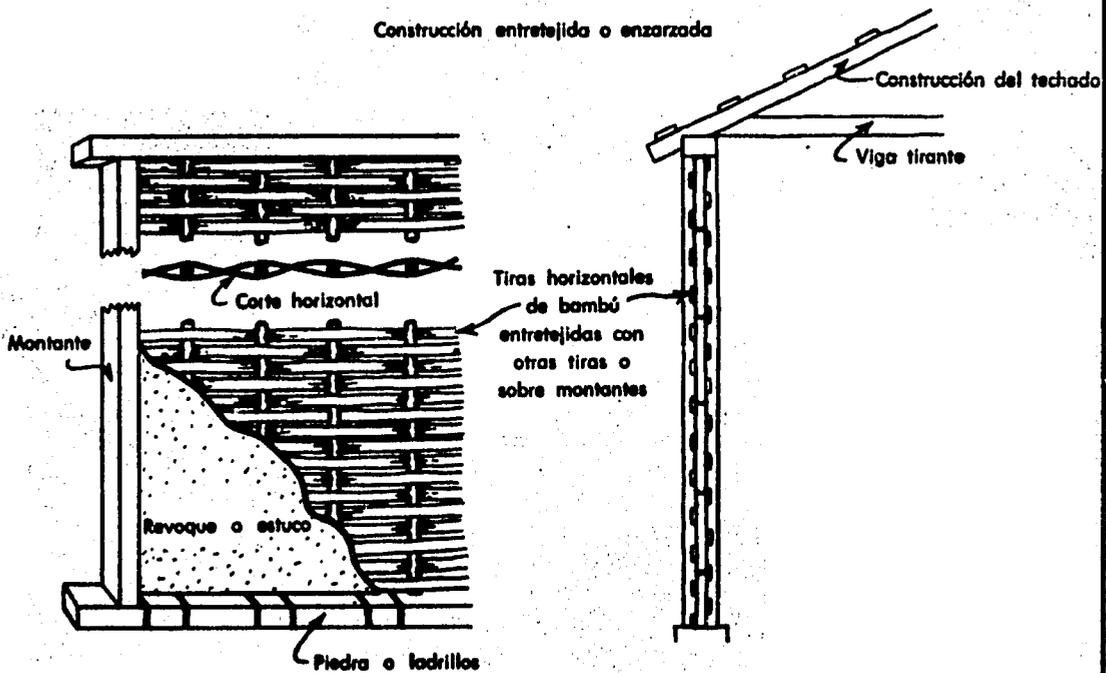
TIPOS DE CONSTRUCCION DE PAREDES HECHAS CON BAMBU
